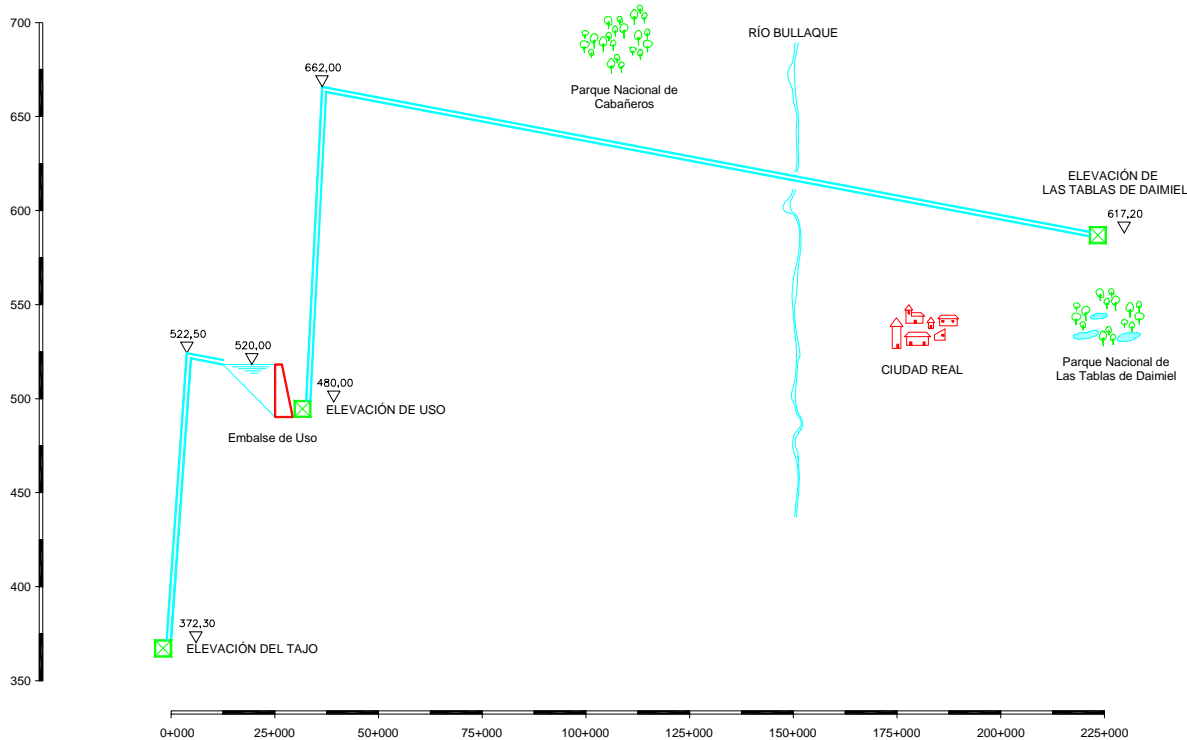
Conducción Aldeanueva-Daimiel. Esquema en alzado
